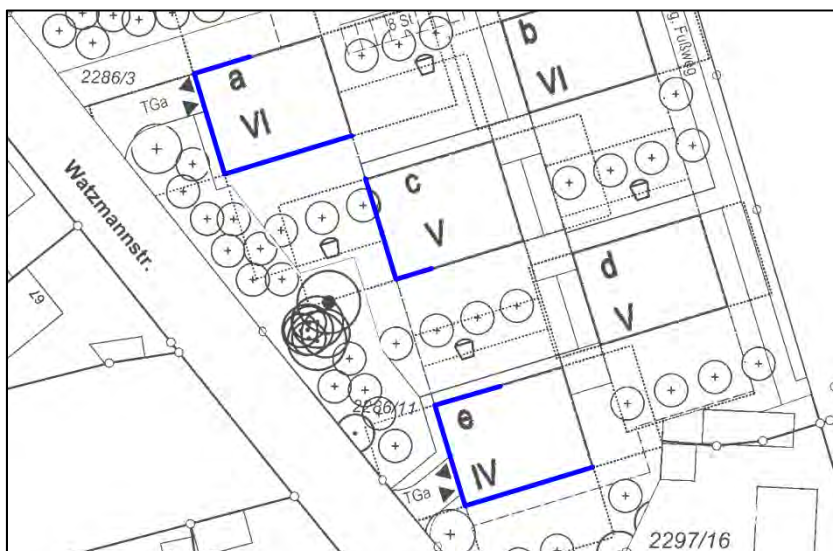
Lageplan mit Kennzeichnung der Fassaden, an denen Schallschutzmaßnahmen im Erdgeschoss und 1. Obergeschoss erforderlich sind
